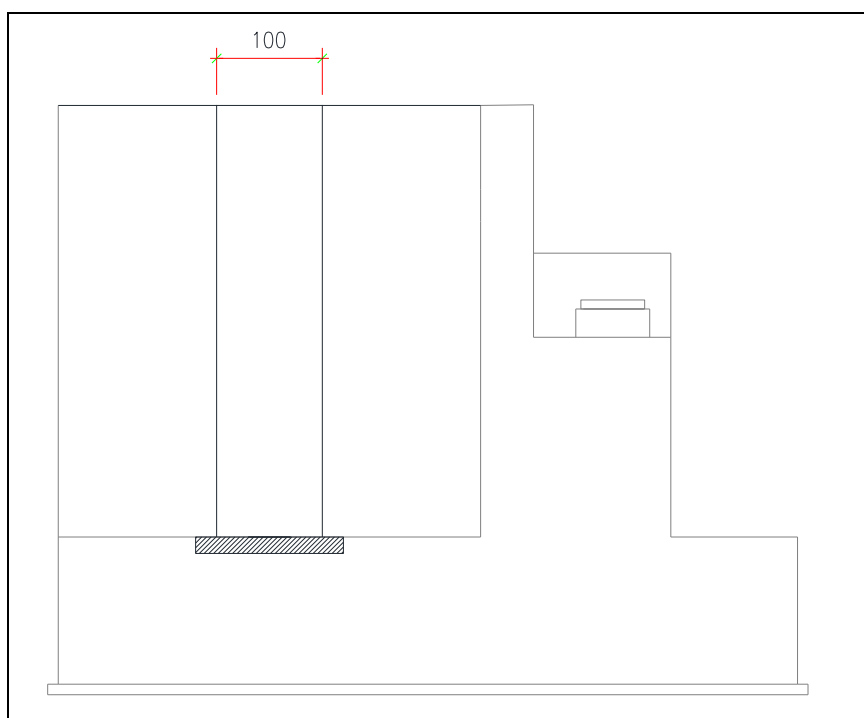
Spalla A - Schema statico equivalente per verifica a taglio muro andatore
